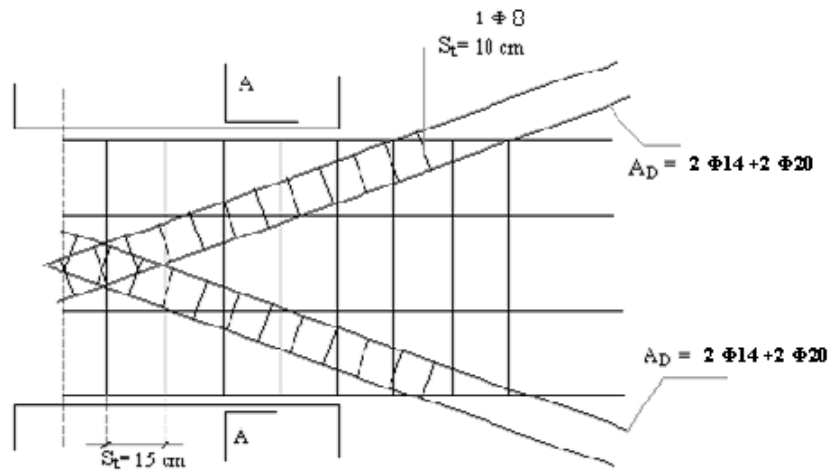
Croquis de ferrailage d'un voile avec ouverture :
